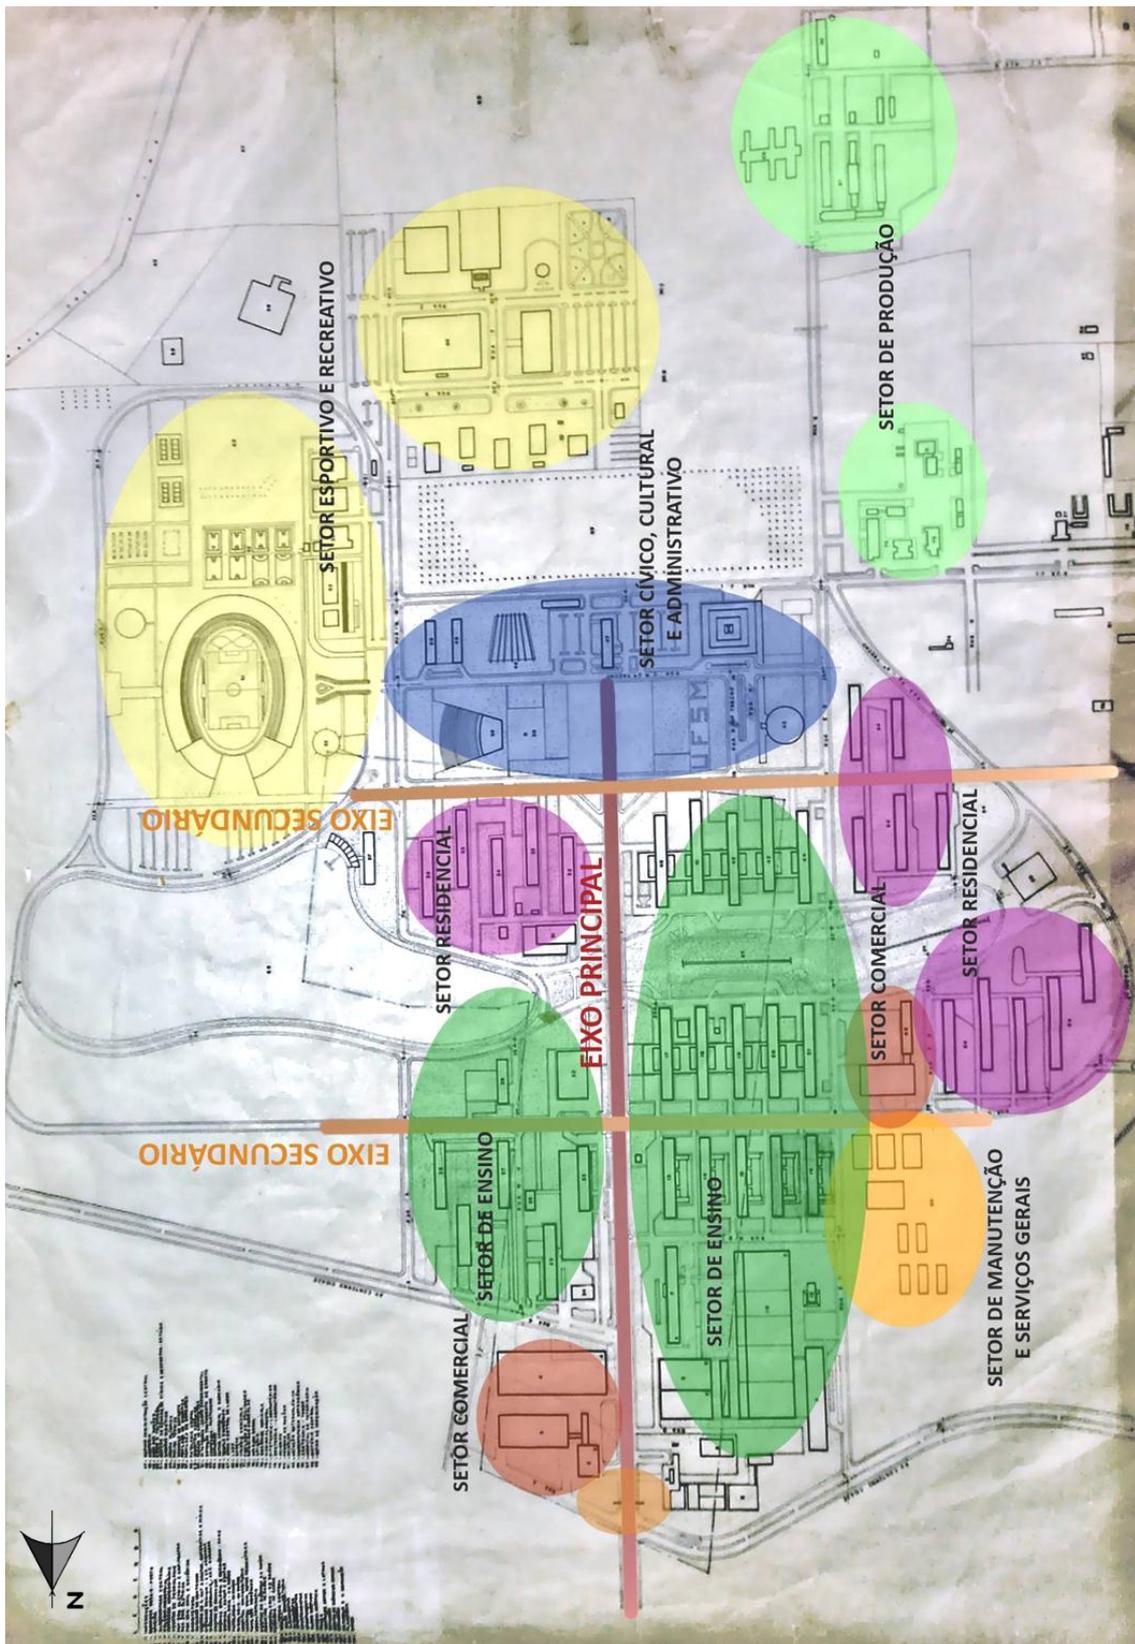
Esquema compositivo do Plano Piloto, sobre planta de abril de 1966. (FONTE: Acervo da UFESM, 2010, modificado pela Autora, 2011).
